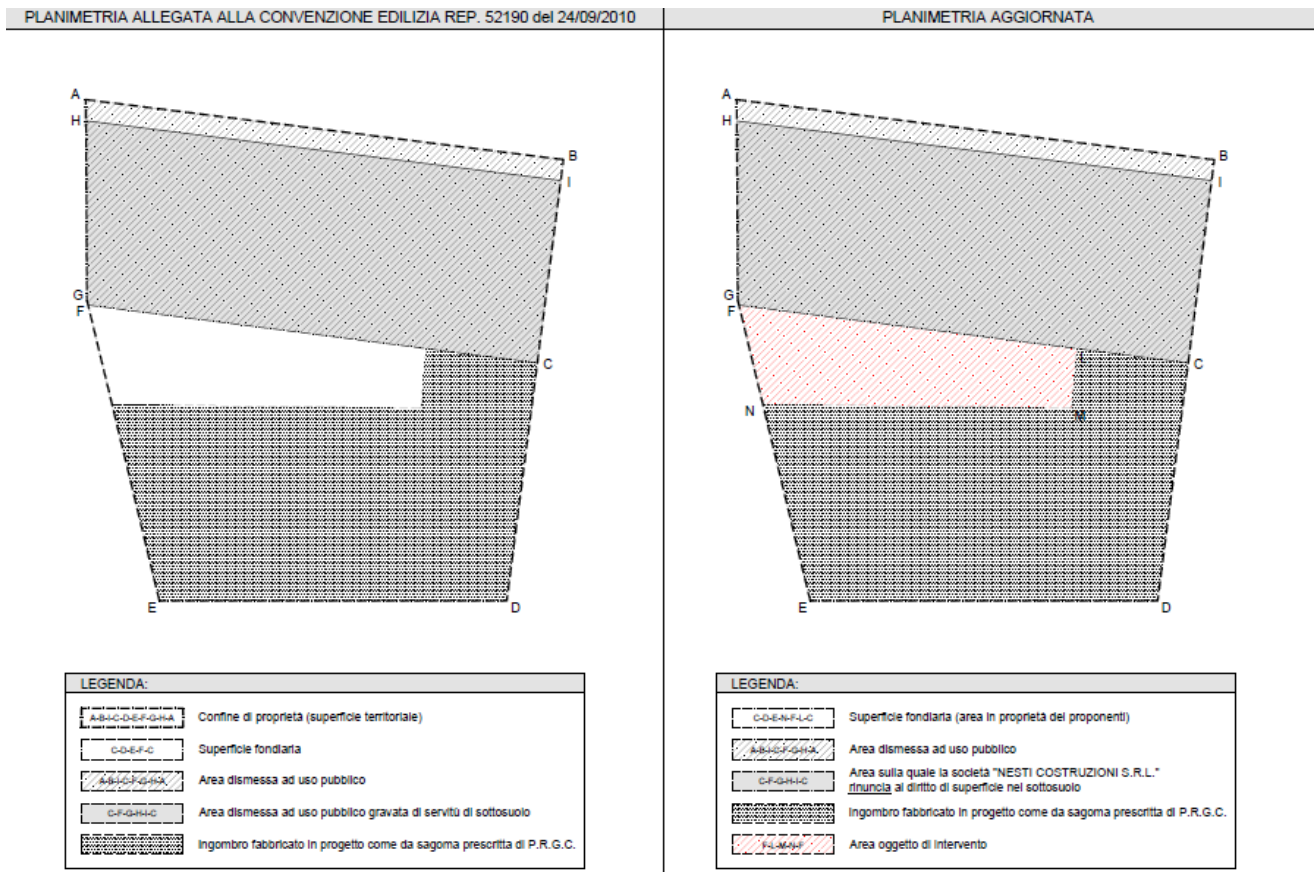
ESTRATTO PLANIMETRIA ALLEGATA A SCIA PER COMPLETAMENTO DEL PIANO INTERRATO
